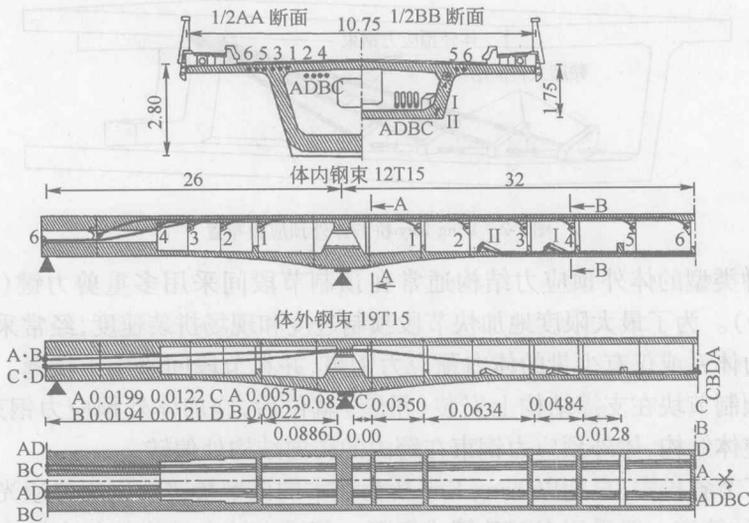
法国 Loir 桥的体内体外钢束布置^[9] (尺寸单位:m)
